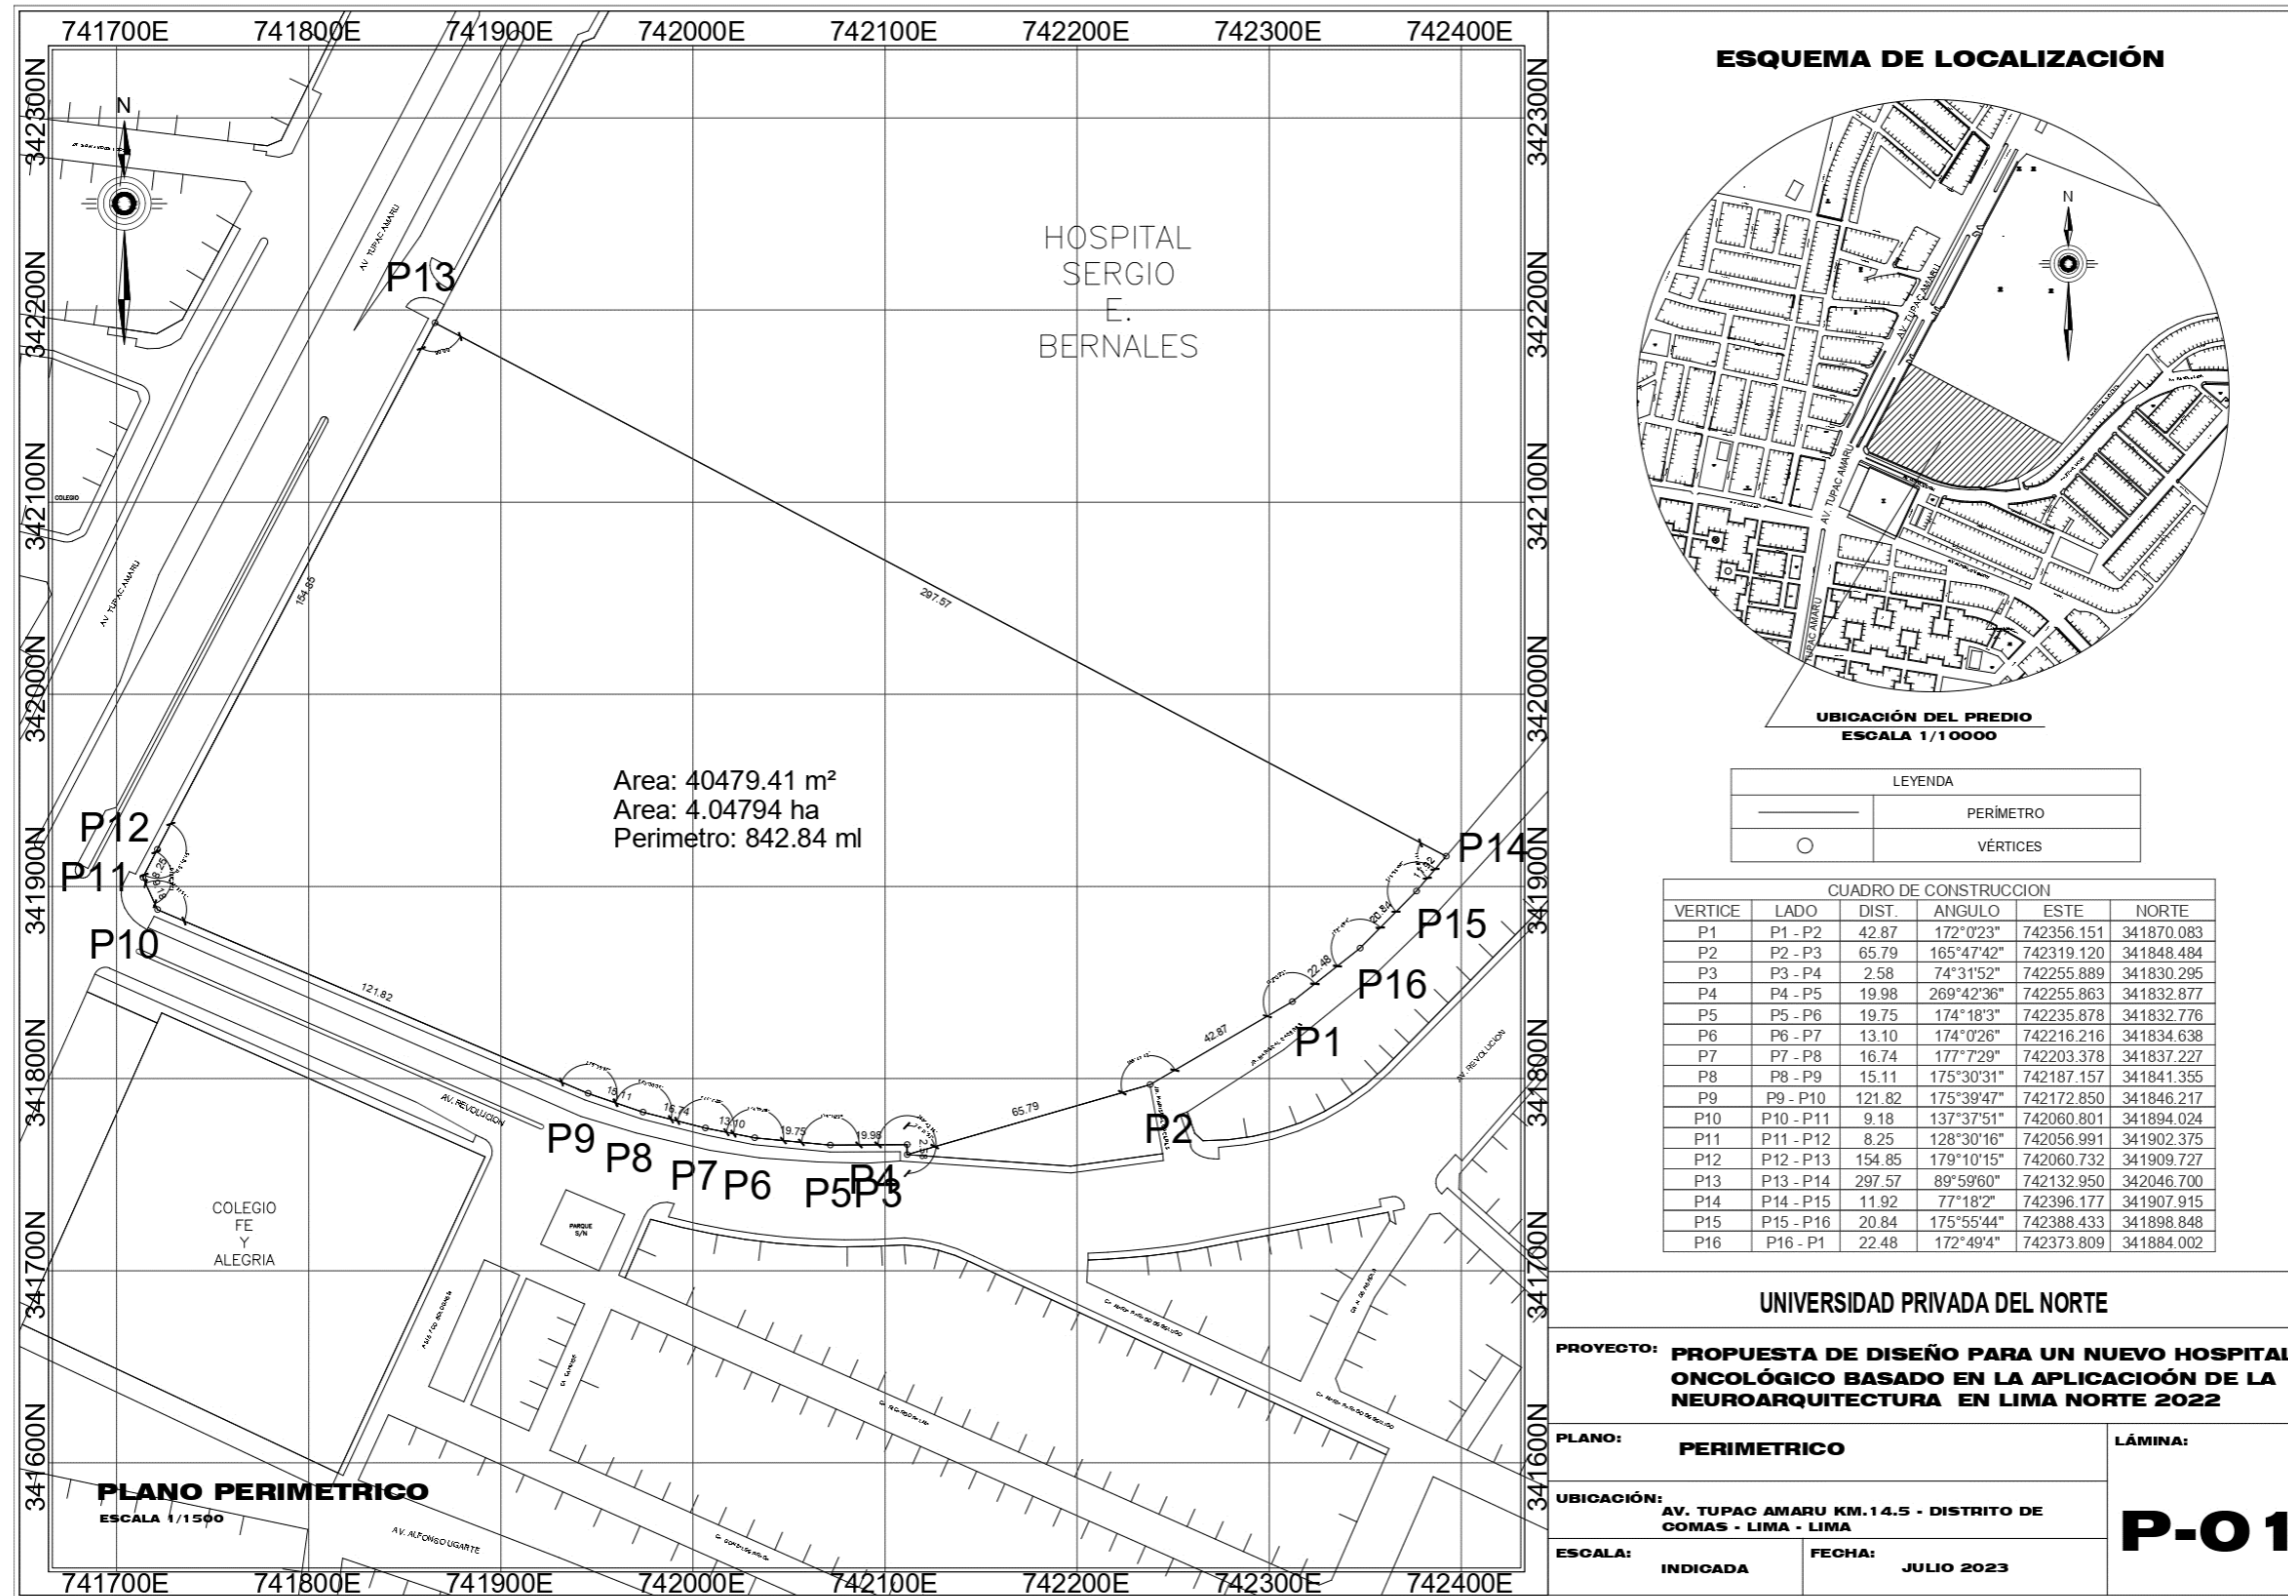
Plano Perimétrico (Fuente: Elaboración propia de los coautores)
